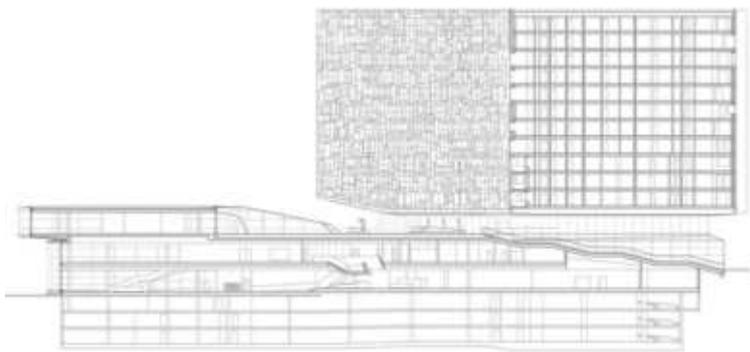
Sección longitudinal del P2 Híbrido, fuente: ArchDaily.
